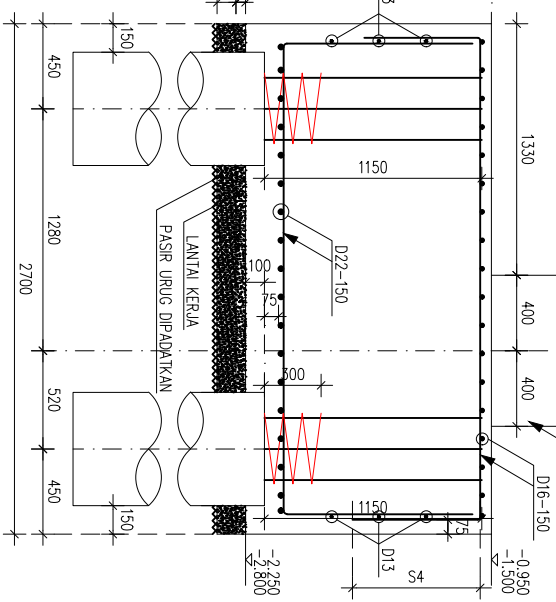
DETAIL PONDASI TIPE PS-1 (T=1000MM)
